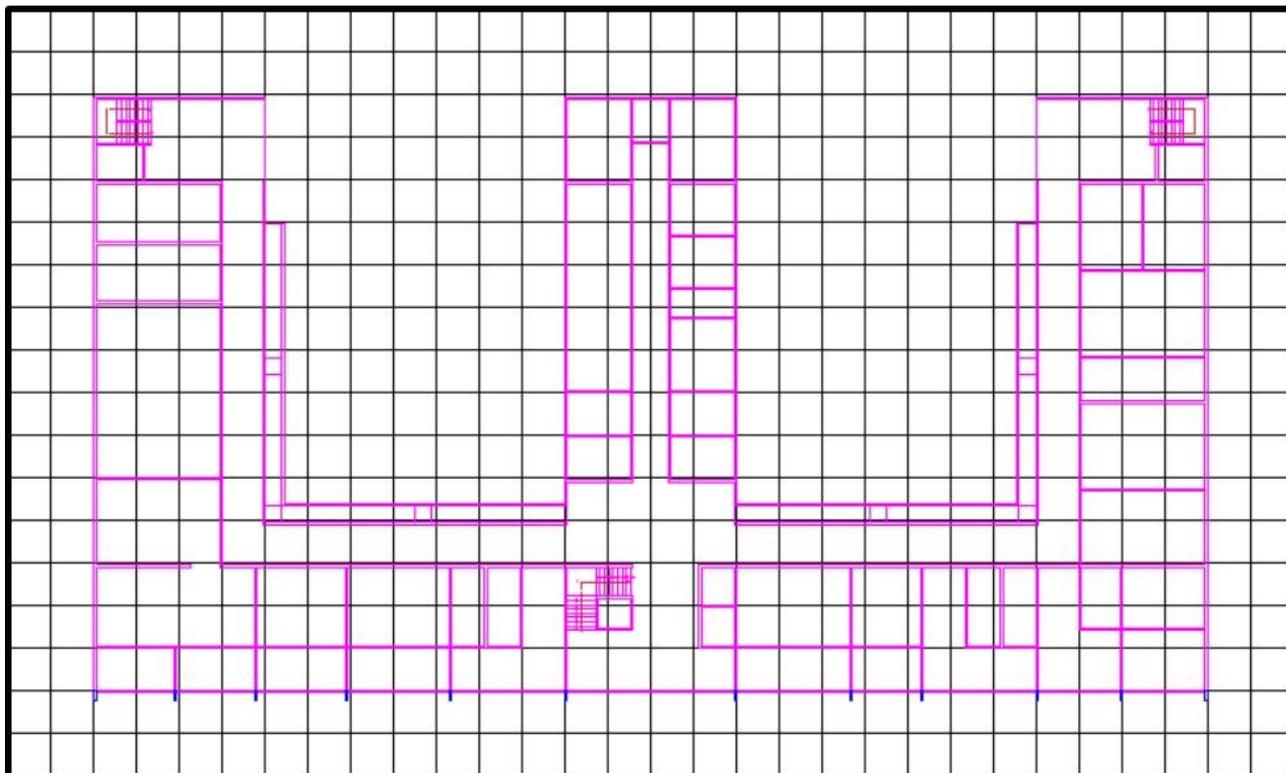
MODULAÇÃO DO SISTEMA ESTRUTURAL - PAVIMENTO TÉRREO
